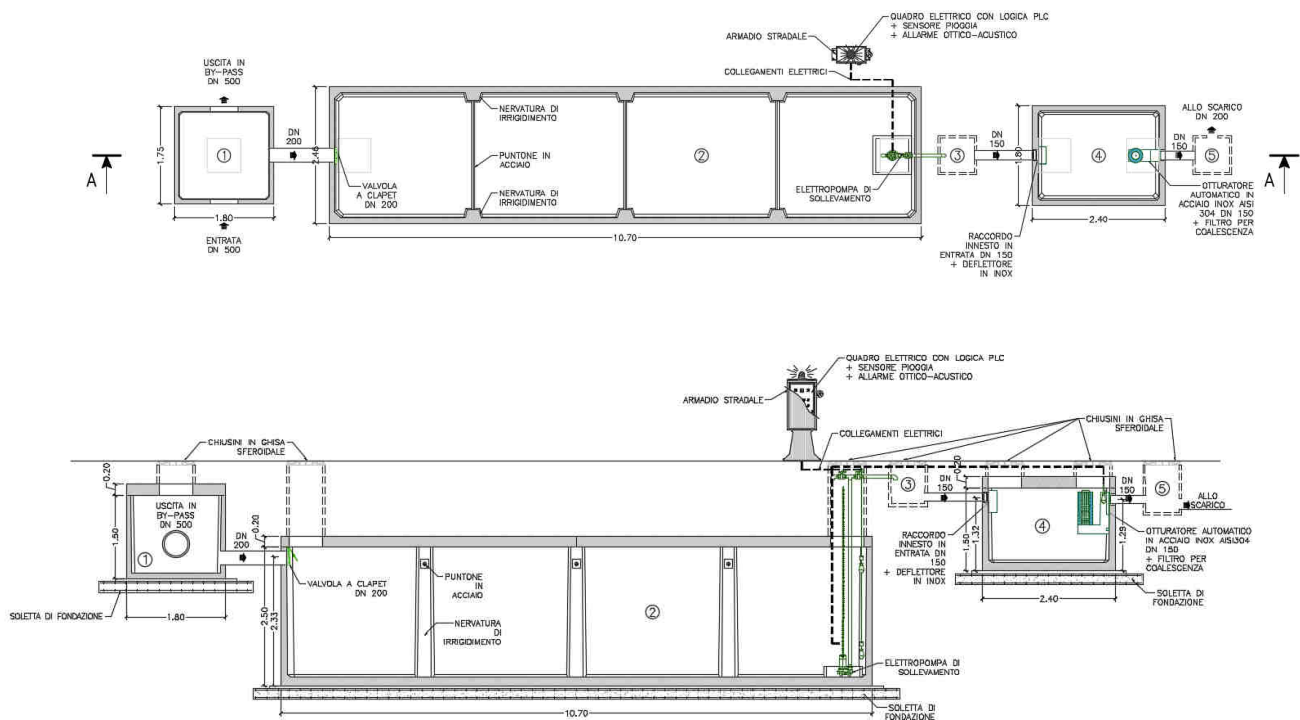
Pianta e sezione vasca di prima pioggia VPP1.
